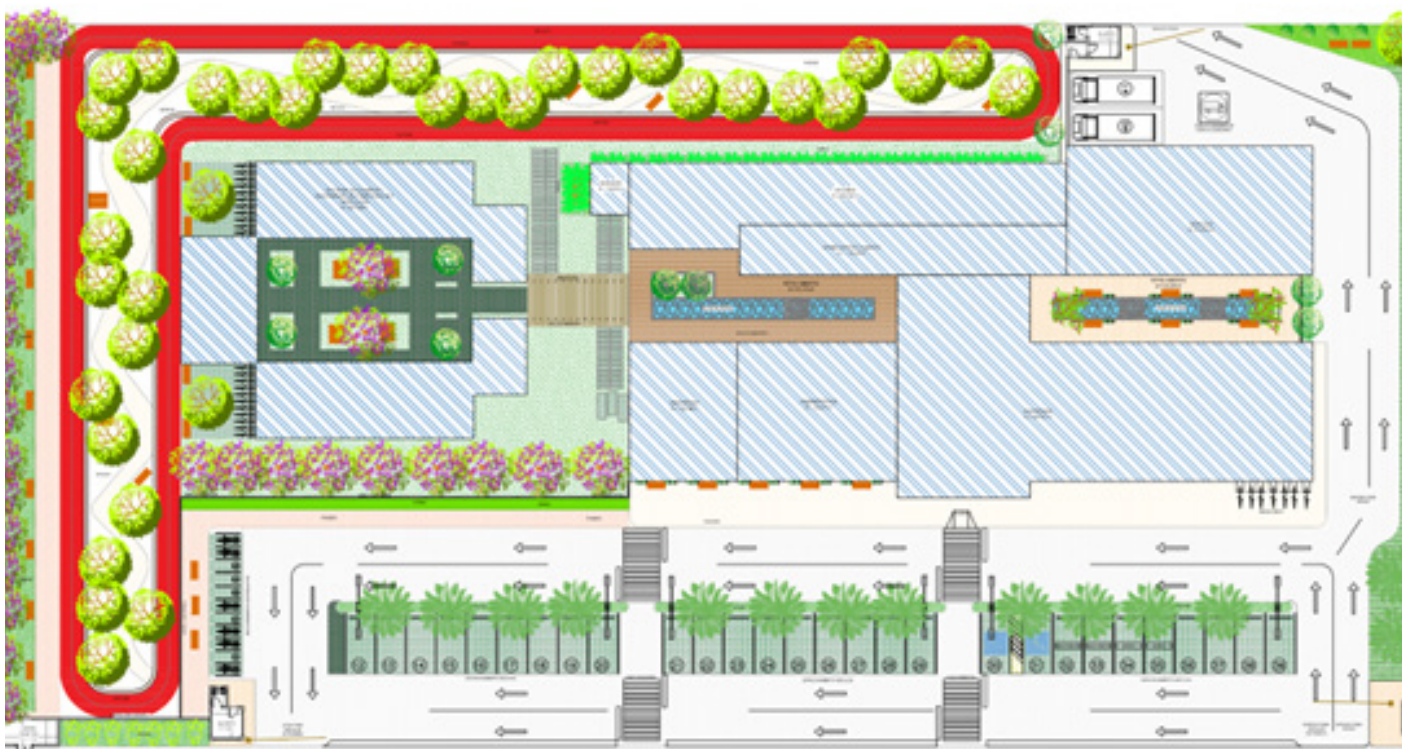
Planta de Implantação do Centro de Acolhimento Aconchego
